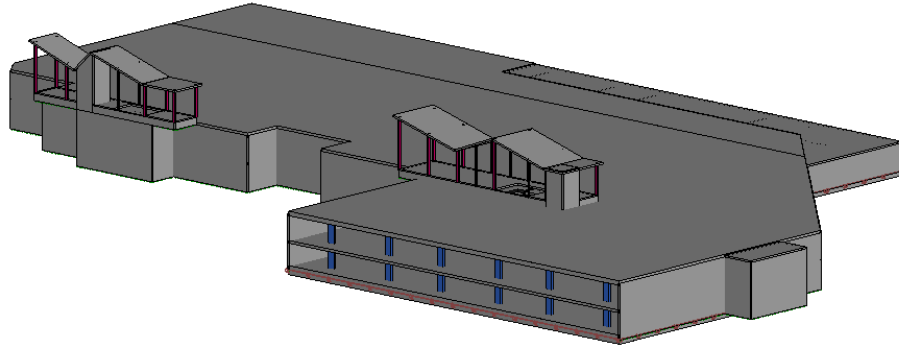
Vista assonometrica di insieme pilastri e muri -FASE 1
